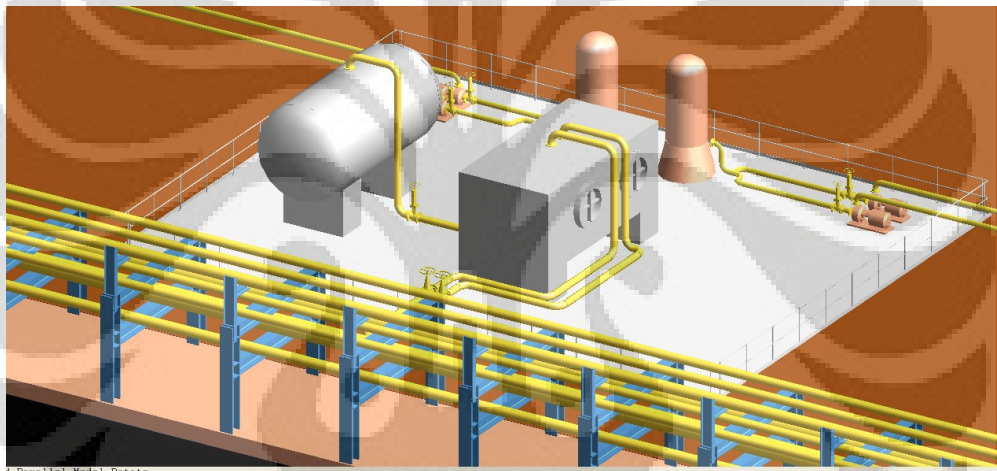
Tampak Depan Model 3D *LNG Storage Facility
